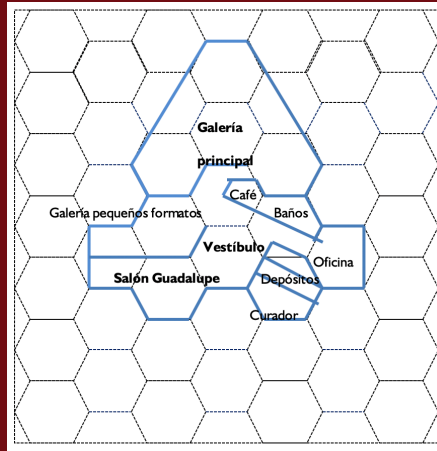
Planta de distribución de Galería de Arte utilizando la grilla
